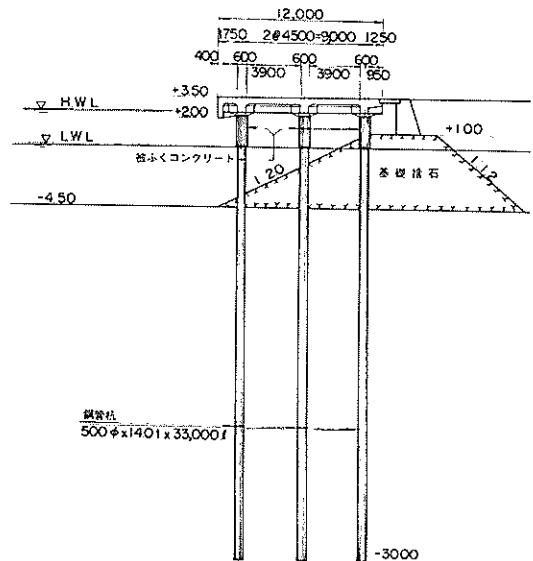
横棧橋式 - 4.5 m岸壁標準断面図
